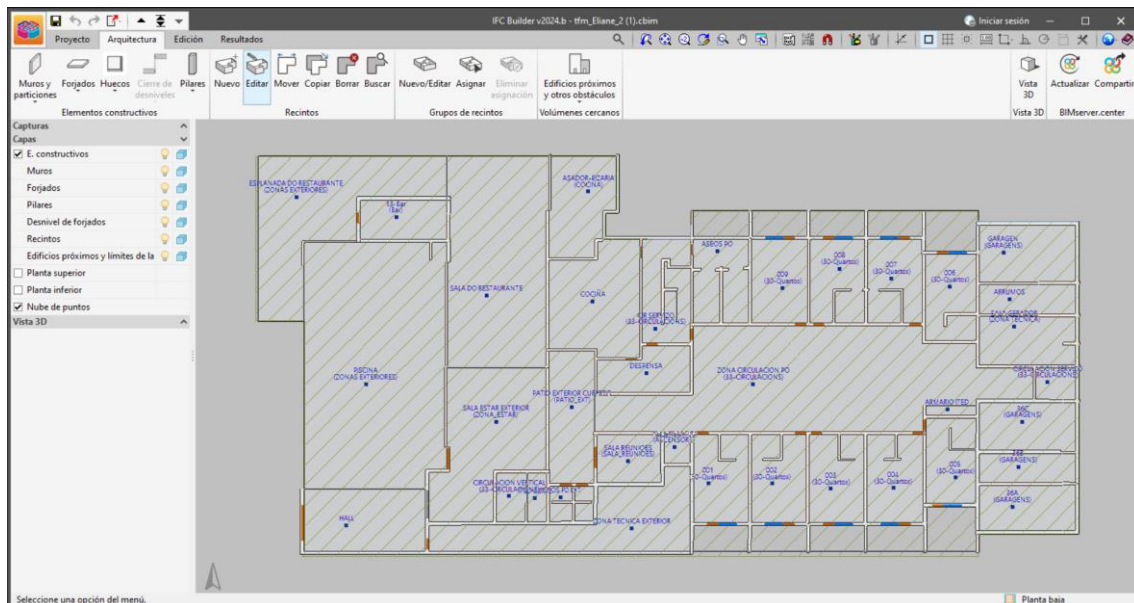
Construção do modelo IFC-Builder planta do rés do chão
